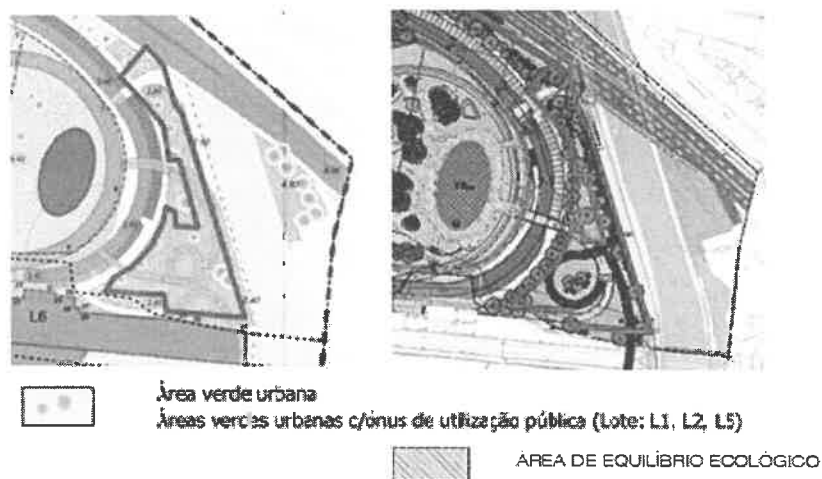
Extrato do quadrante nascente da Planta de Implantação do PPMDFRJ, Fig. 14 – Extracto do quadrante nascente da Planta de Síntese da Op. Loteamento (a vermelho – área em questão)
